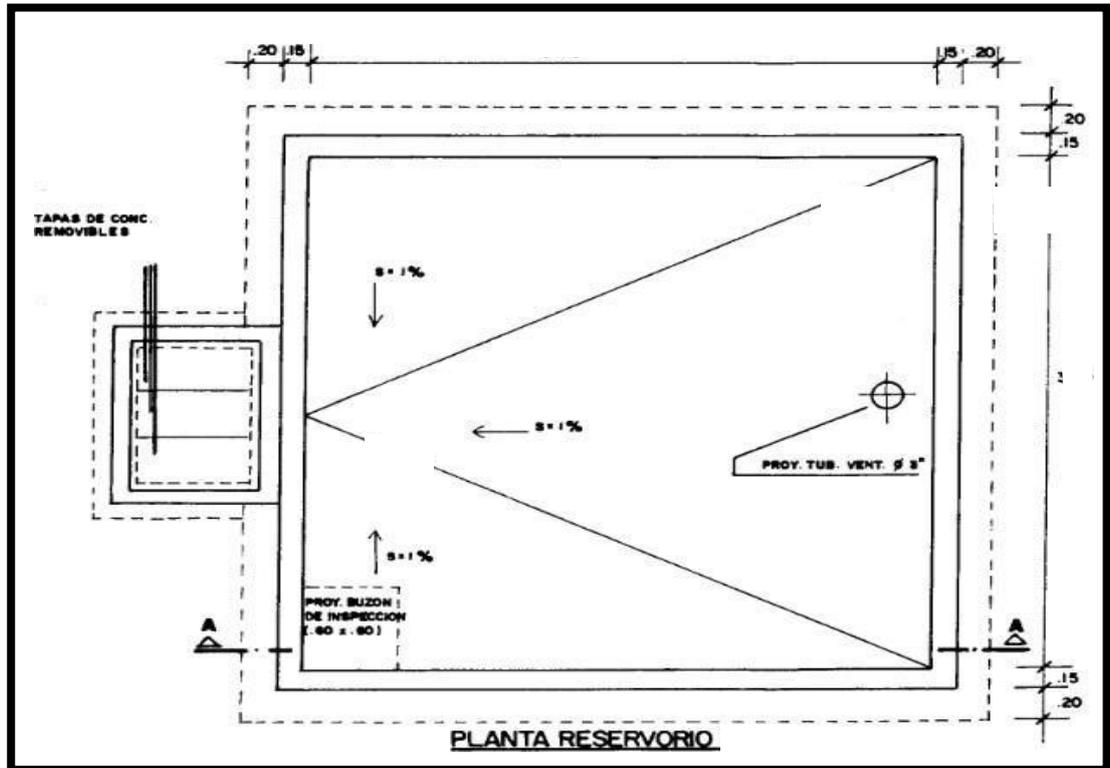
Reservorio Rectangular Apoyado - Vista en Planta
